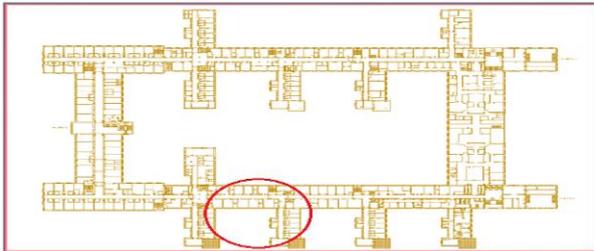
Plano Planta 5ª Sur. Ubicación de La Sala de Fisioterapia.
